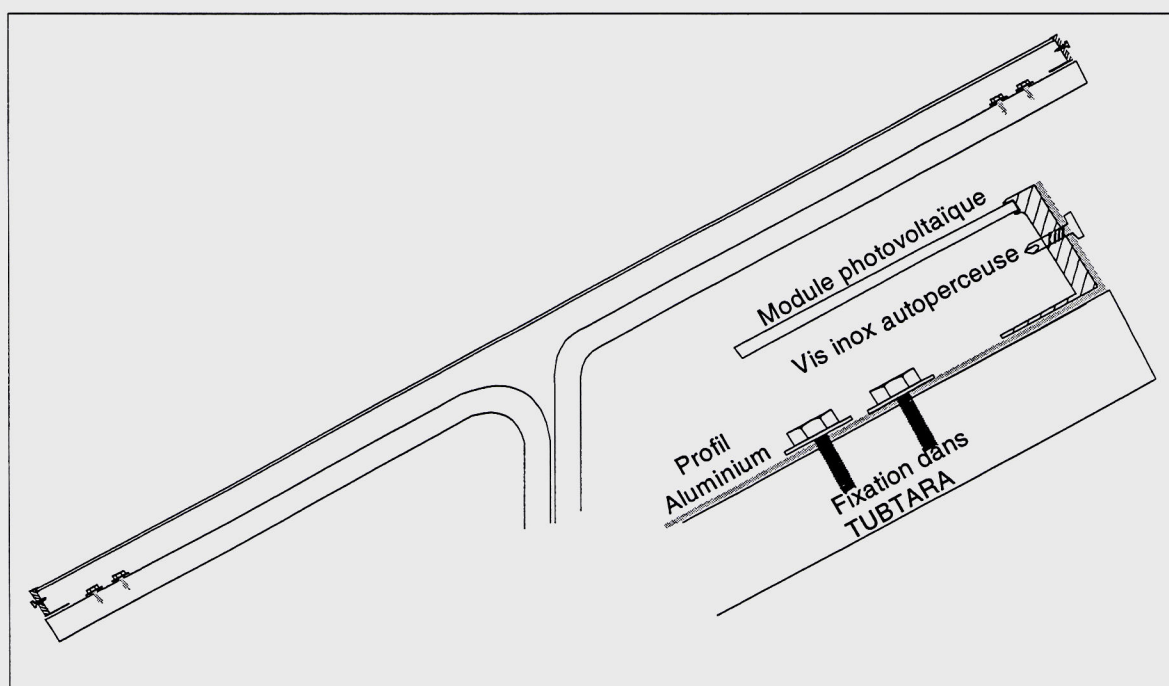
Vue en coupe du système de fixation des modules sur les profils transversaux
